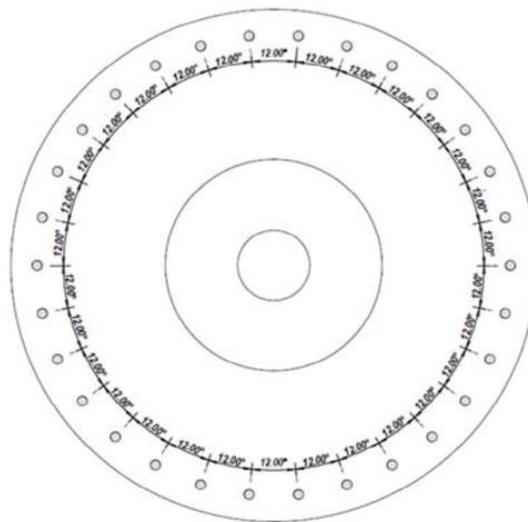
Andamento geometrico della fondazione (pianta – non in scala).
